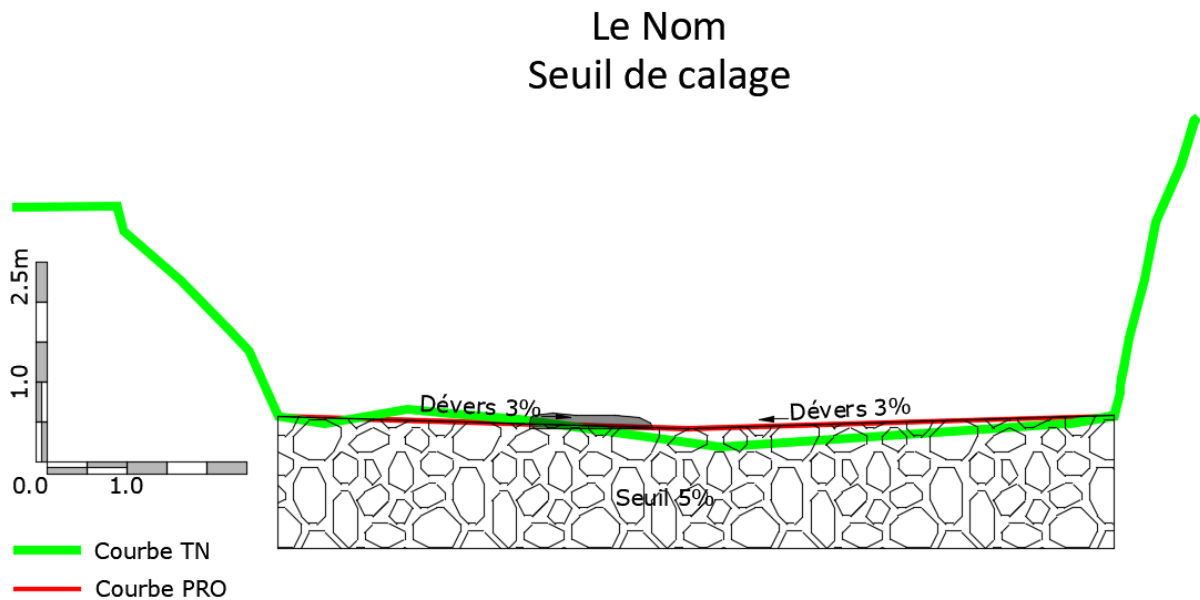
Coupe type du seuil de confortement de la traversée de la conduite EU
